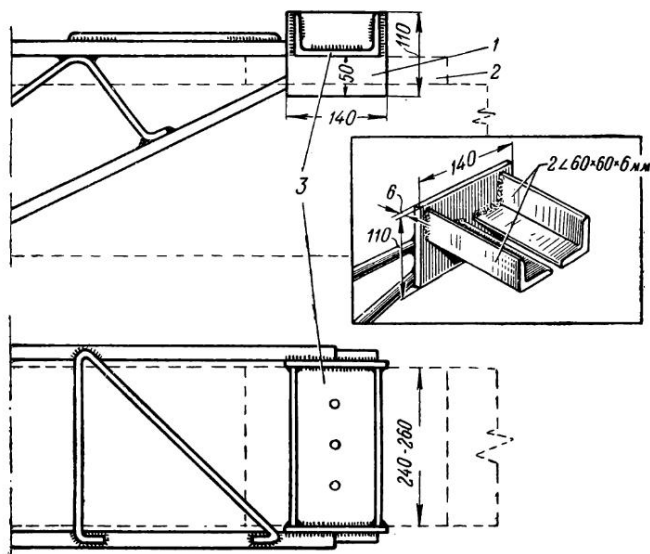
Деталь конструкции верхних опорных планок в двух облегченных вариантах:
